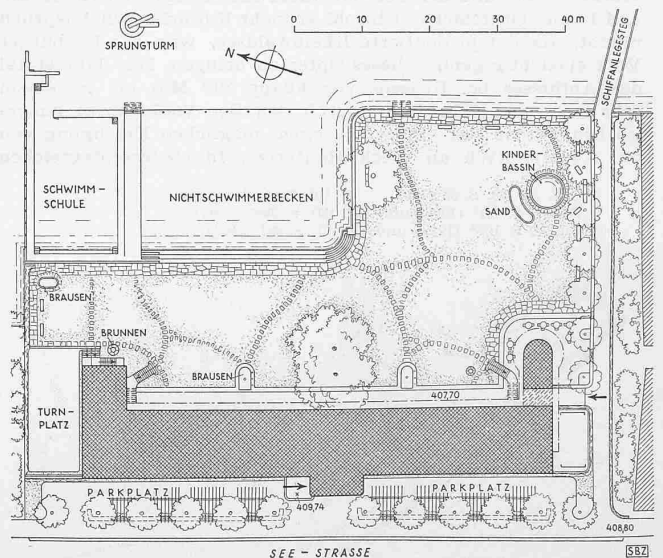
Badanstalt Zürich-Wollishofen. Lageplan 1:1000
